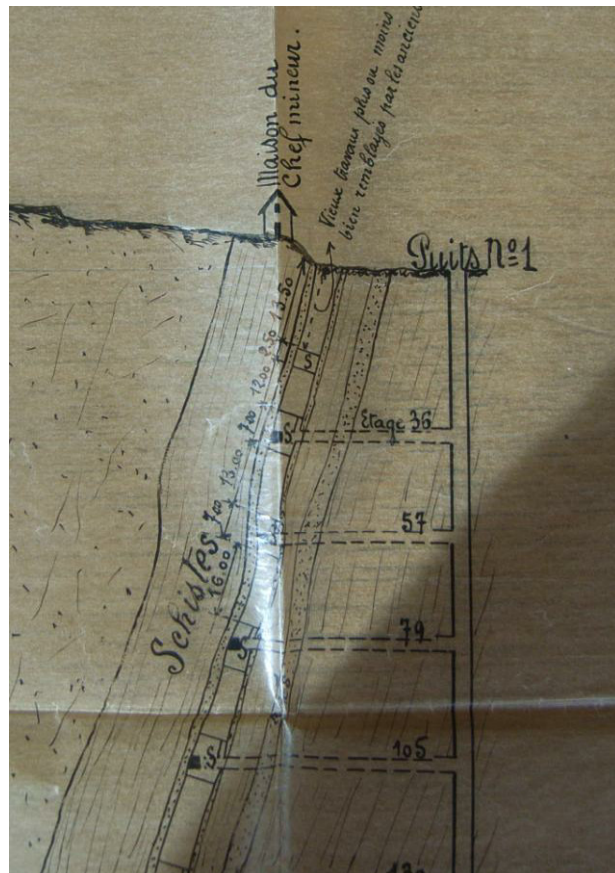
coupe des travaux (1917) dans le plan du puits 1 et du fontis de 2008.
